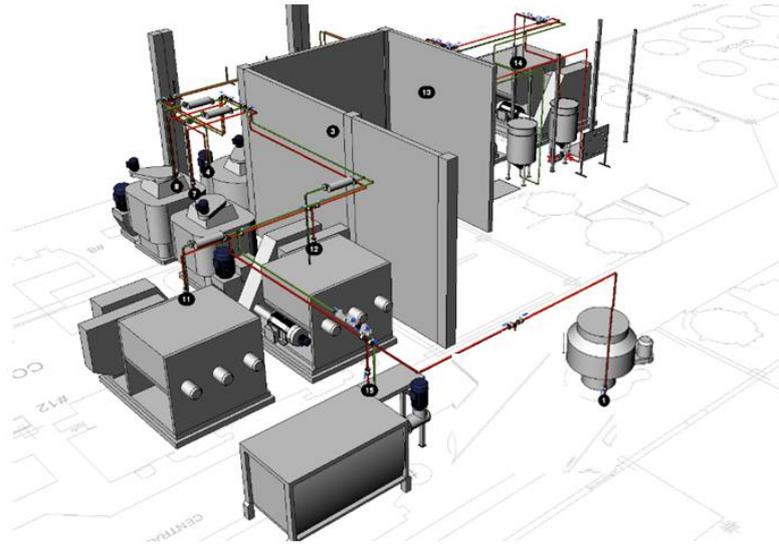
Ruta de tuberías en llegada a conchas, vista posterior.
